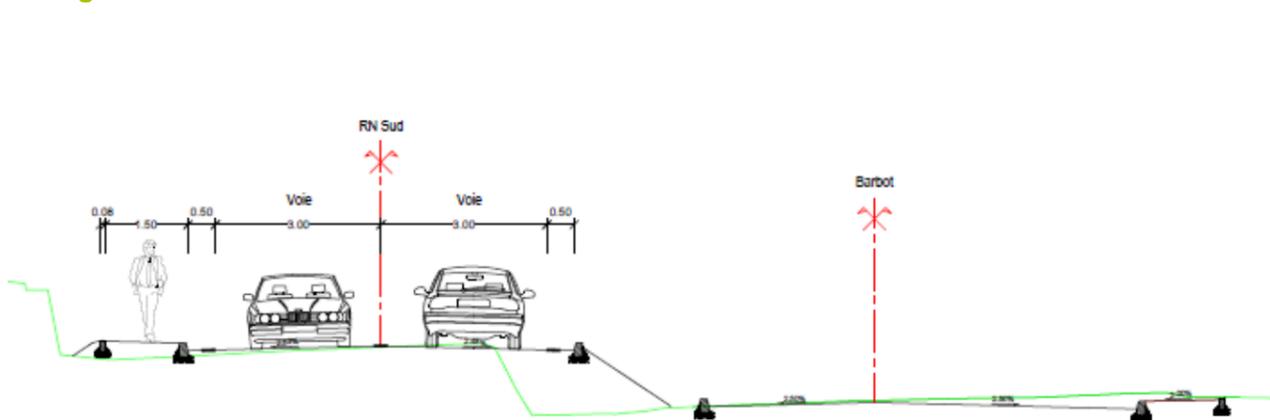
Profil en travers de la RN Sud au Sud du carrefour RN94 / Avenue du général Barbot
